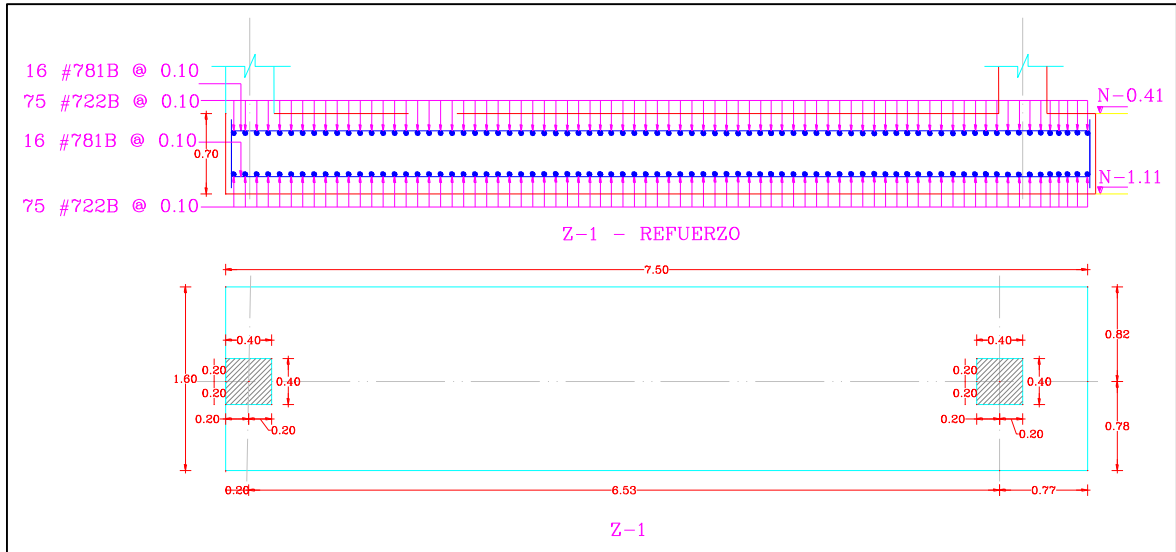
Detalle de refuerzo zapata Z-1.
